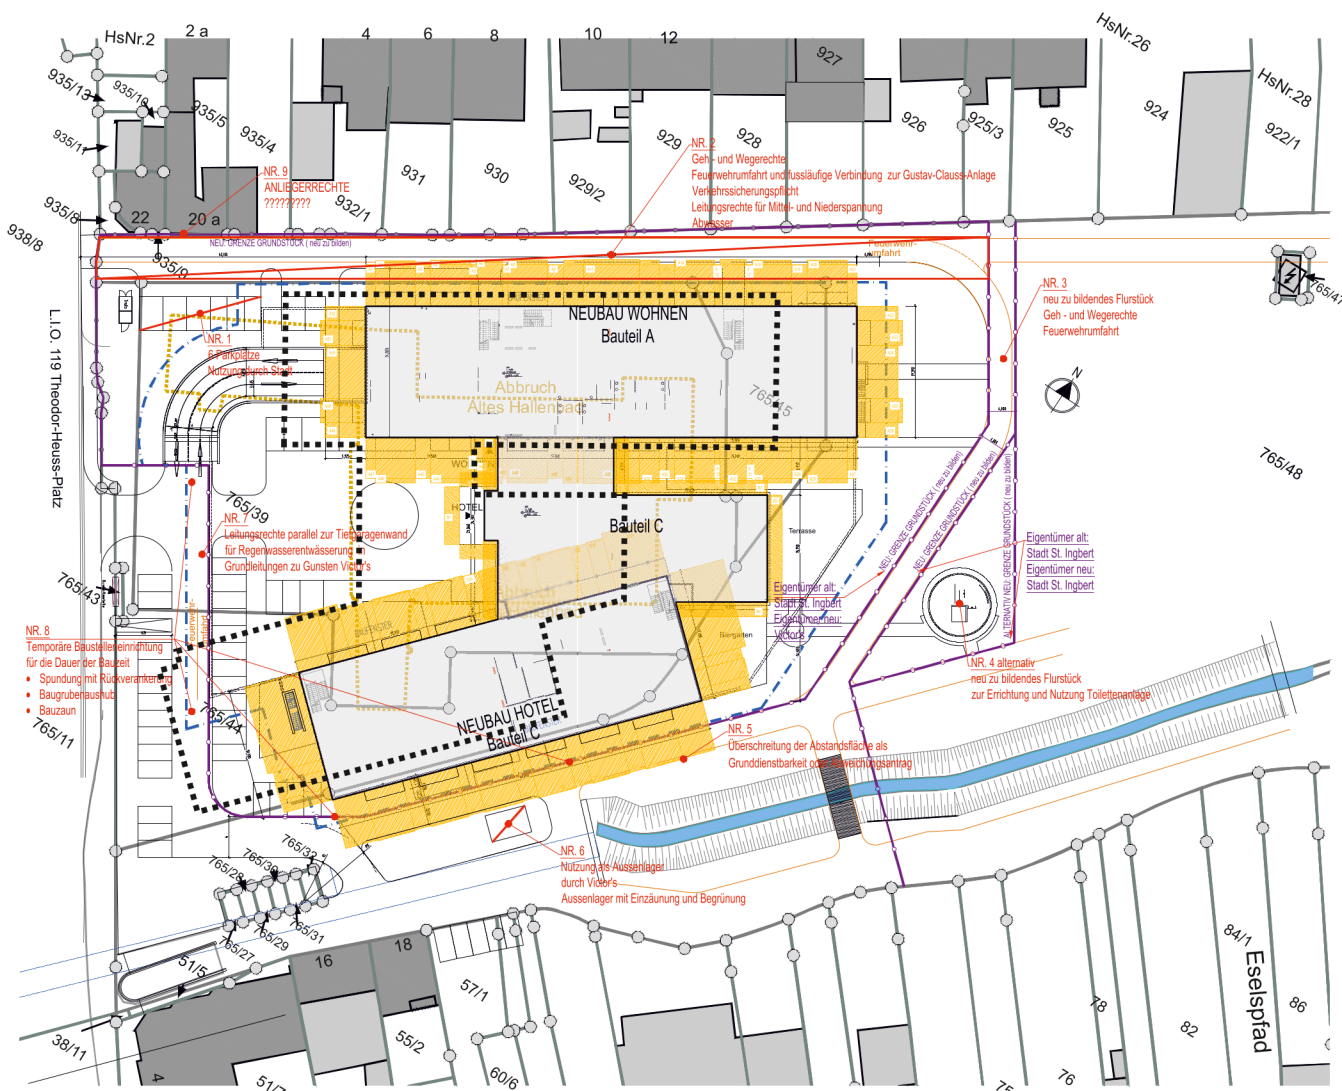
Lage- und Abstandsflächenplan, Planungsentwurf für das Bauvorhaben Hotel und Wohnen in St. Ingbert
